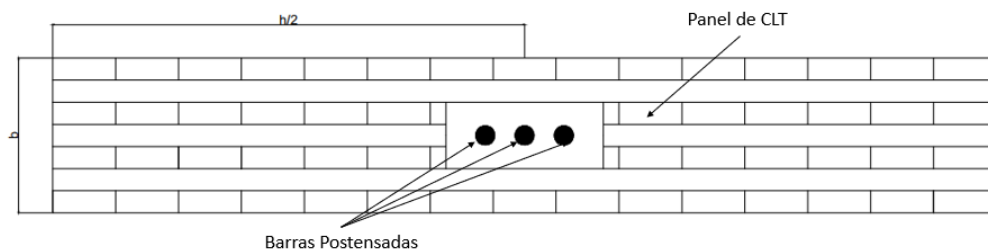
Detalle, sección transversal muro postensado de CLT.
